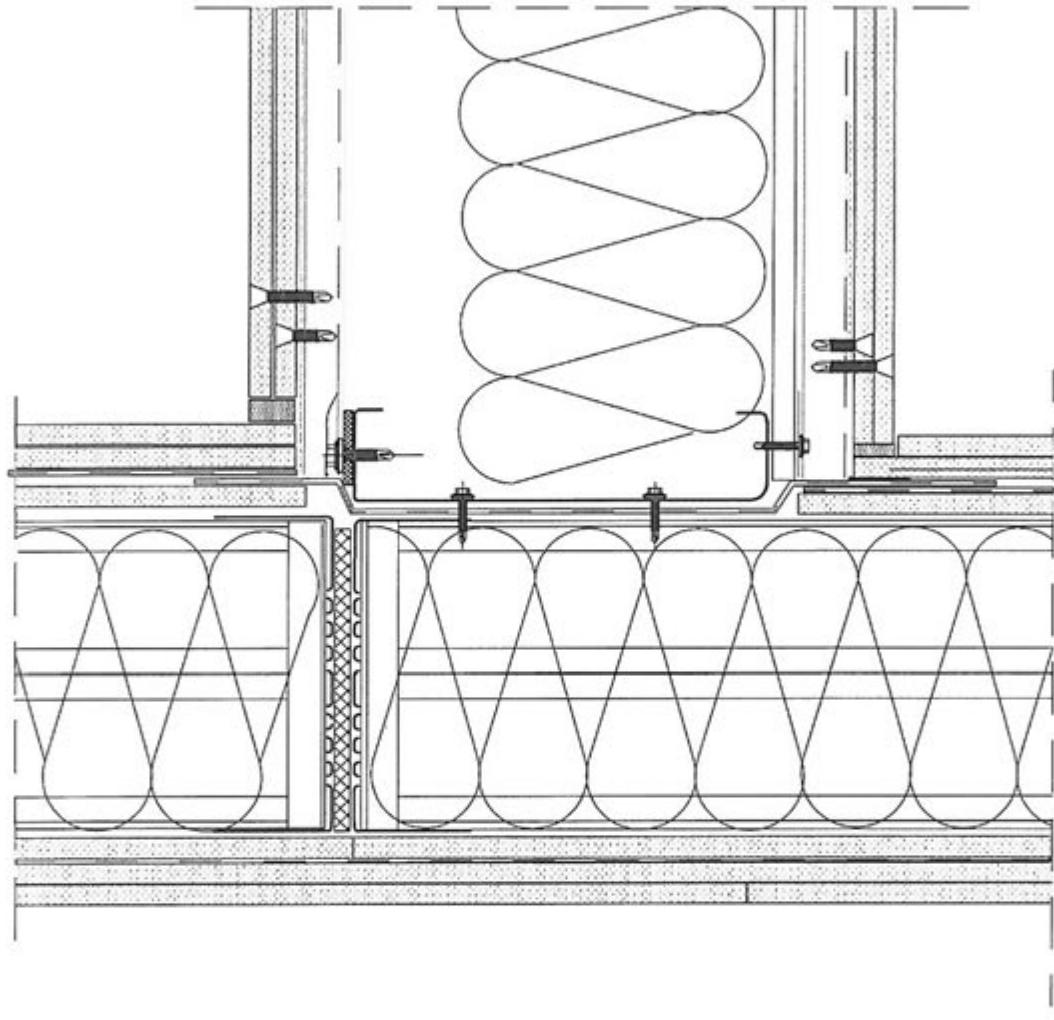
Узел крепления и примыкания конструкции междуэтажного перекрытия к внутренней несущей продольной стене.
